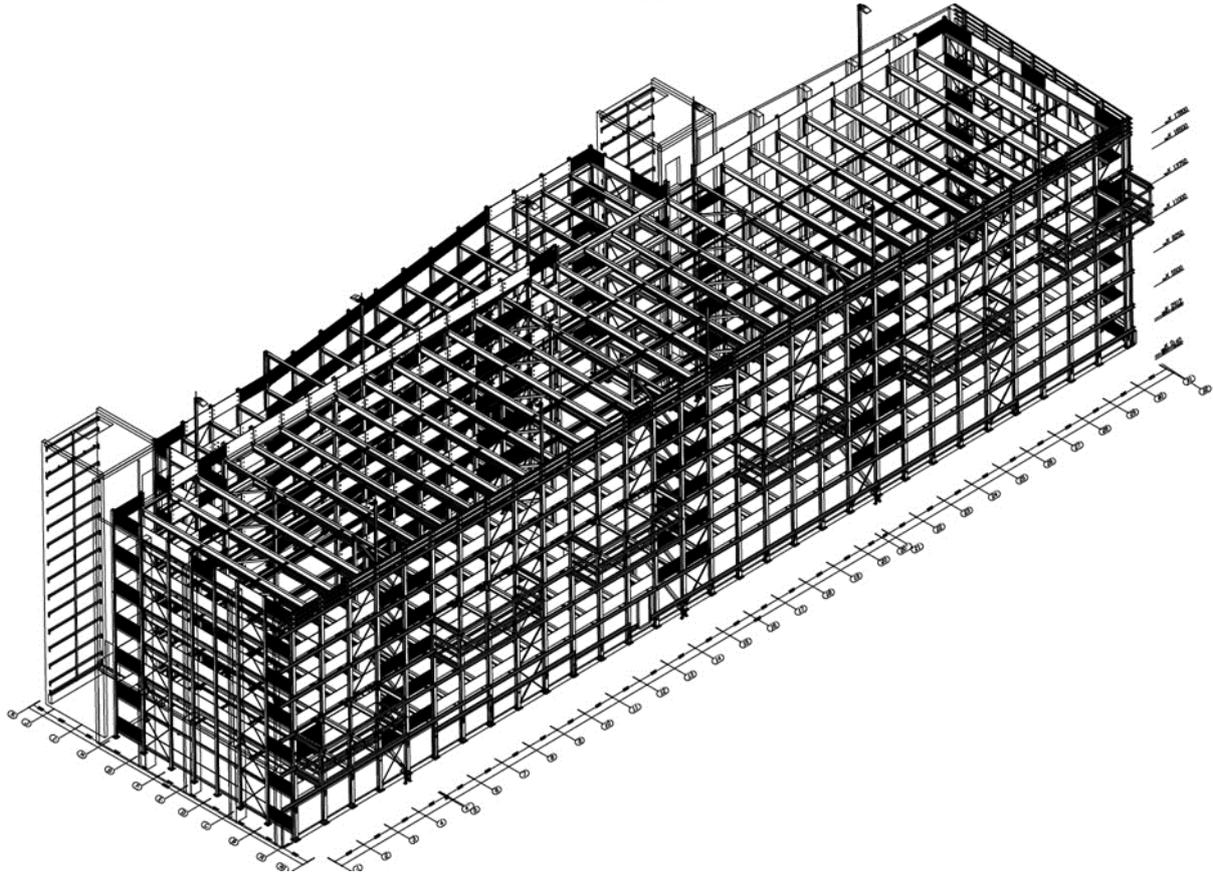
Parkhaus Hofaue in Wuppertal mit Vollgeschossrampen
